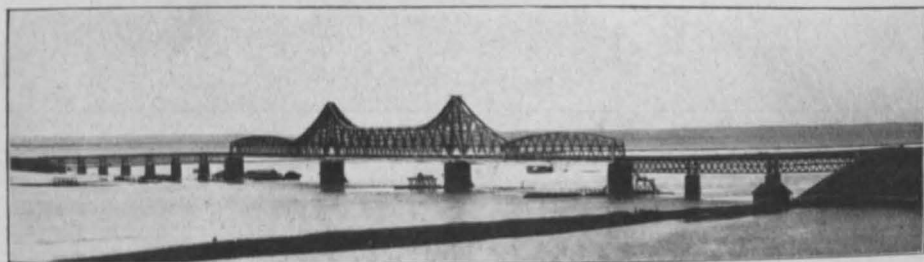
Donaubrücke bei Czernavoda (Nebenöffnungen). 1895.
